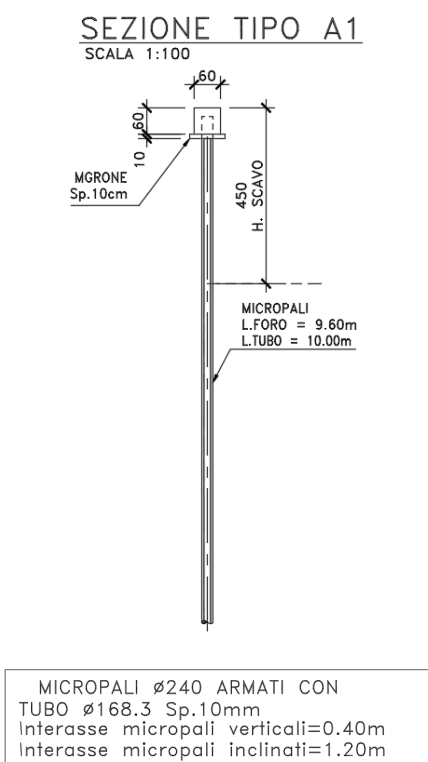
Sezione Paratia "Sezione tipo A1"
